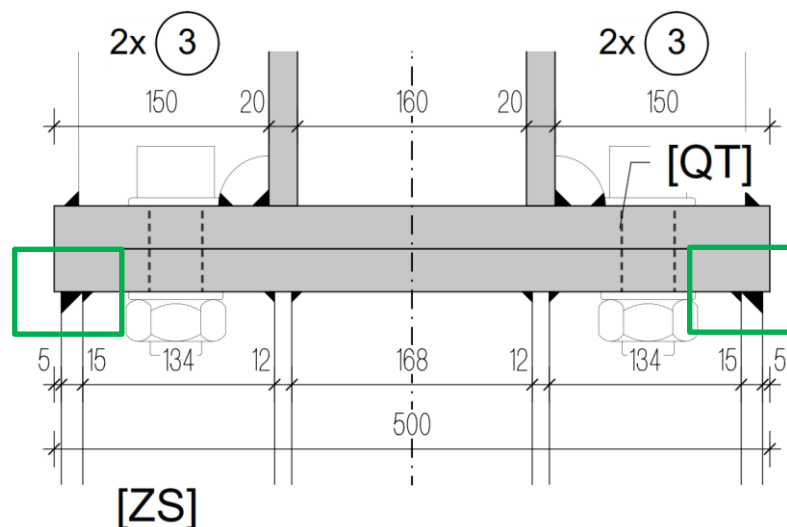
Ansicht der Schweißnähte Endplatte LD_{ULS}06 am Beispiel [QT]_{geschlossen}
